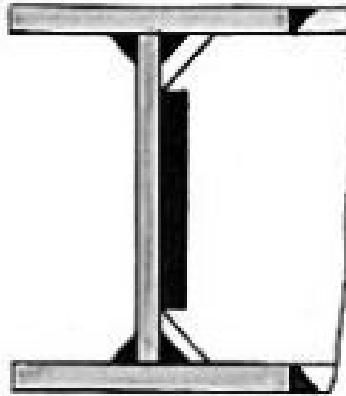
Unión a 90° de dos perfiles I de la misma altura, alas soldadas a tope y almas en ángulo. En negro se representa la zona con soldadura [23, pag, 774]
